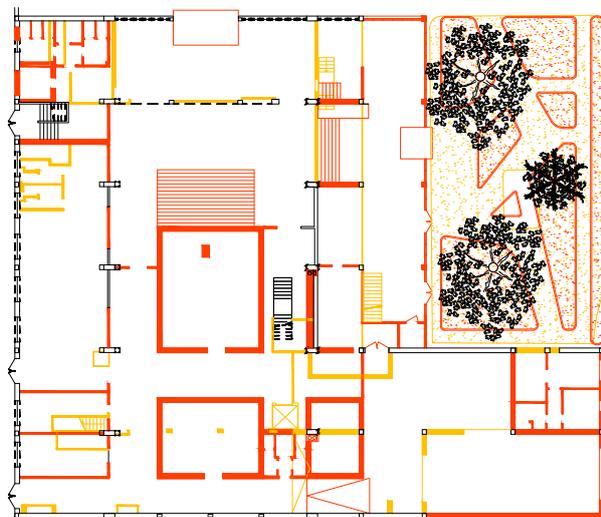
Planimetria demolizioni e costruzioni - Piano terra.
